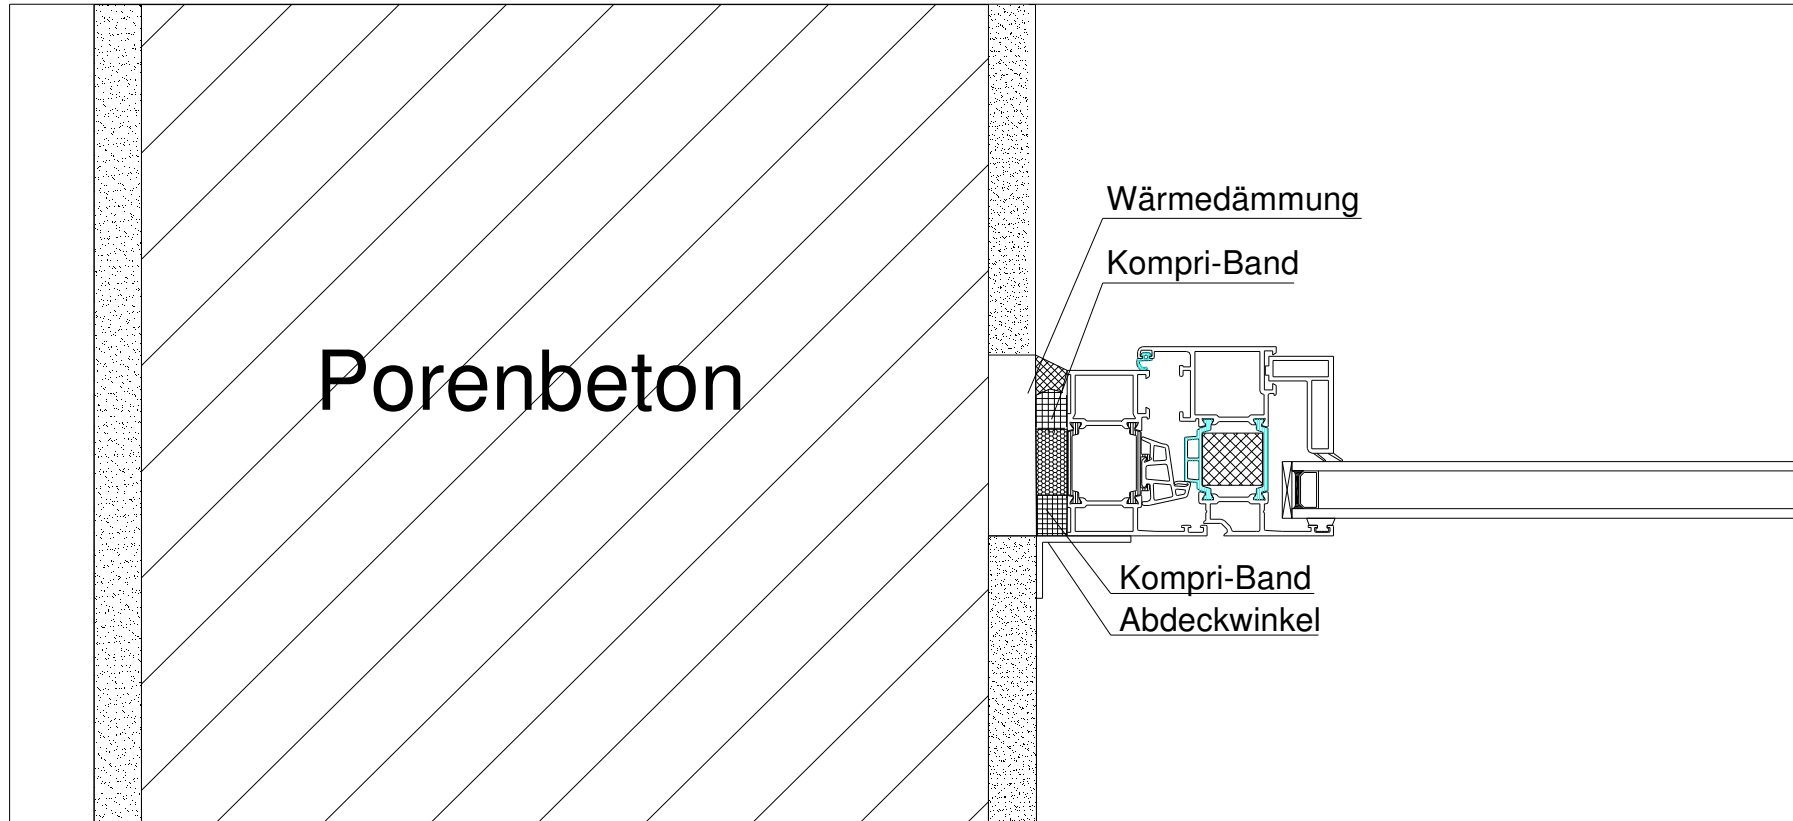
Senkrechter Wandanschluss, Mauerwerk mit Putz, Aluminium-Unterbauelemente, Putz unterbrochen
